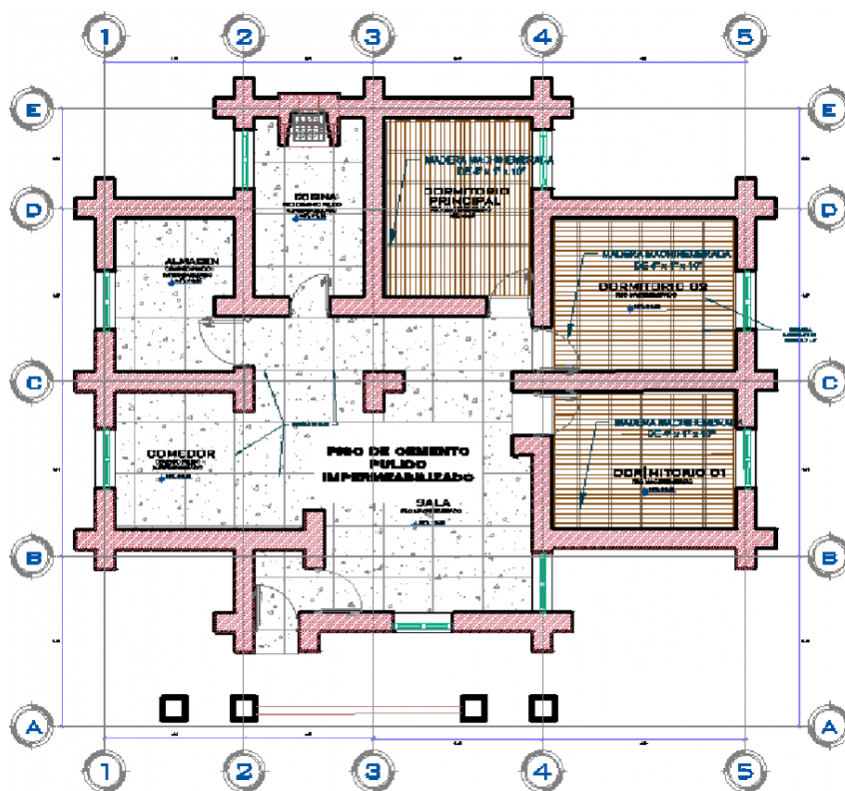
Detalles de proceso constructivo del piso en la vivienda
